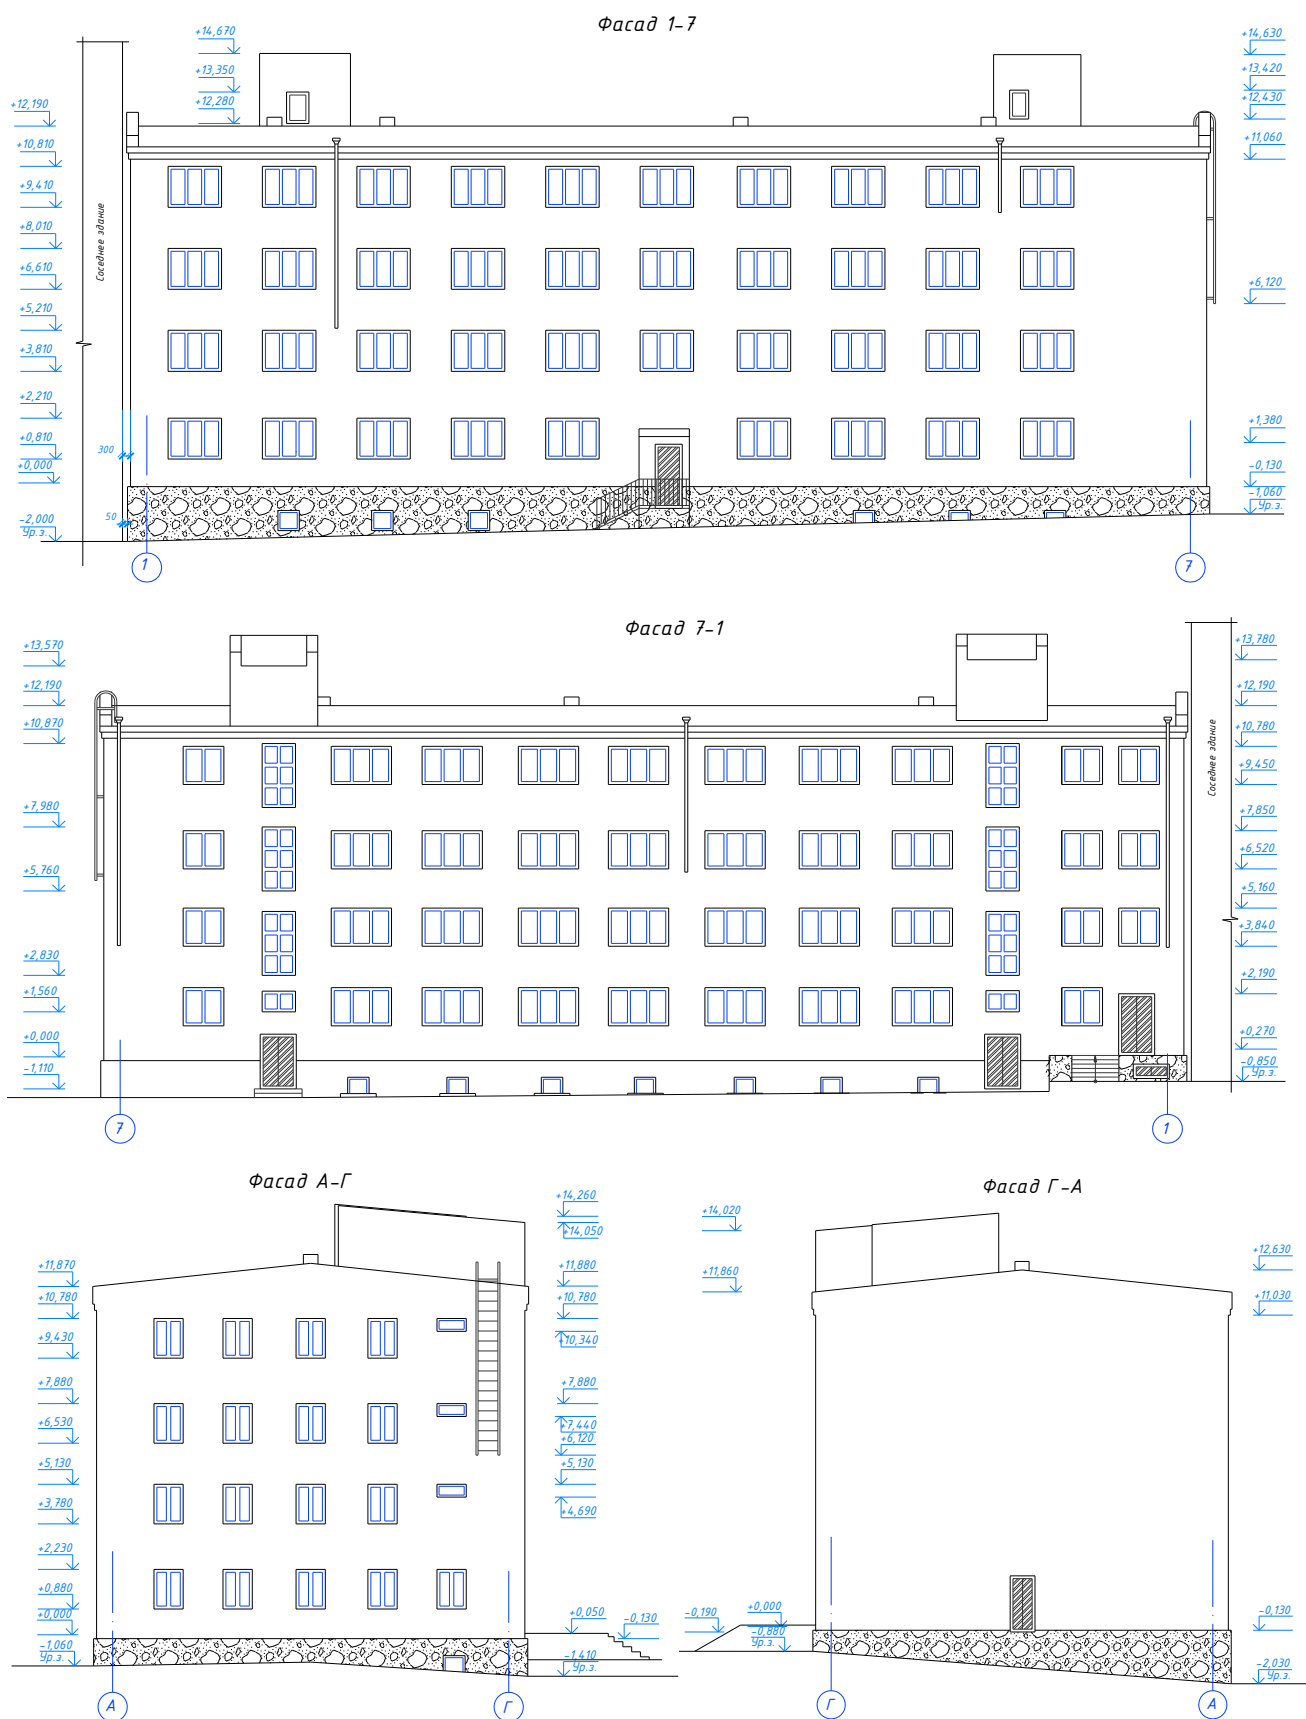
Схема фасадов 4-этажного здания в г. Новочеркасске
